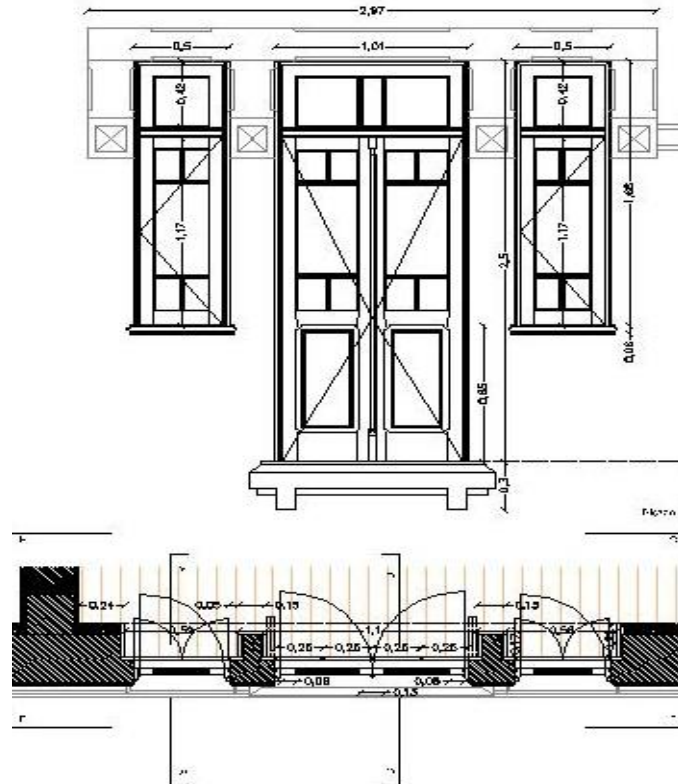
Plano de pormenor de um envidraçado antigo. [5]
